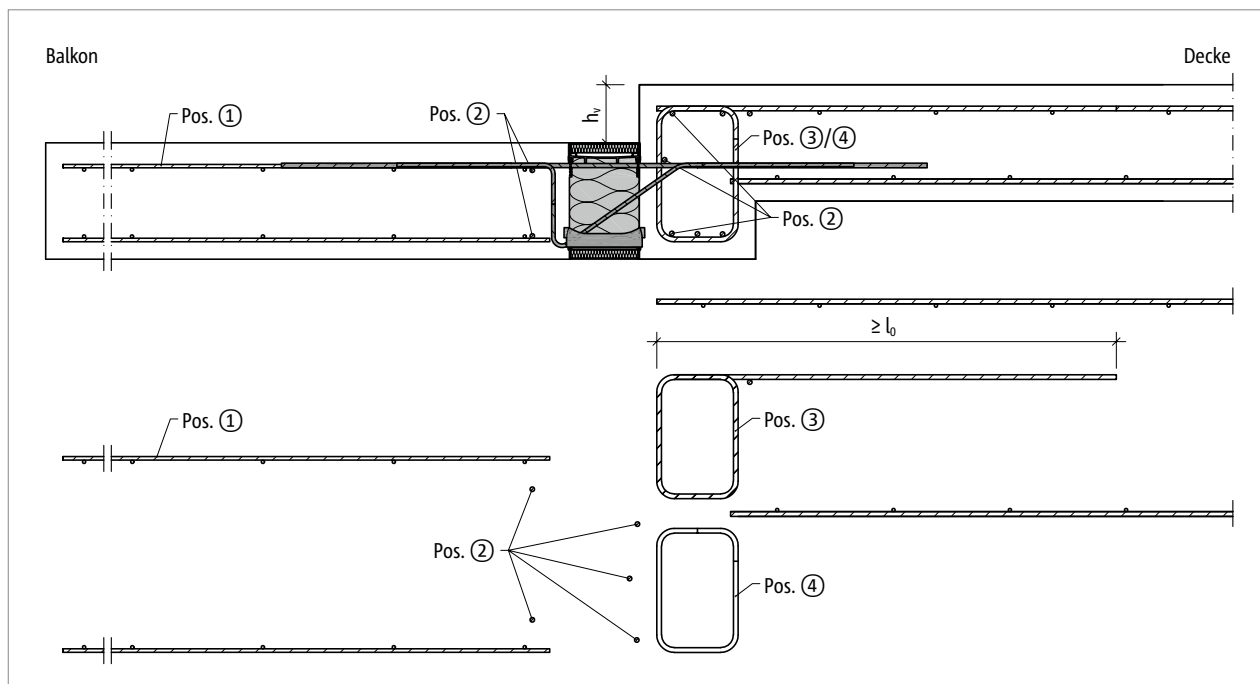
Schöck Isokorb® XT Typ KL: Bauseitige Bewehrung für kleinen Höhenversatz
